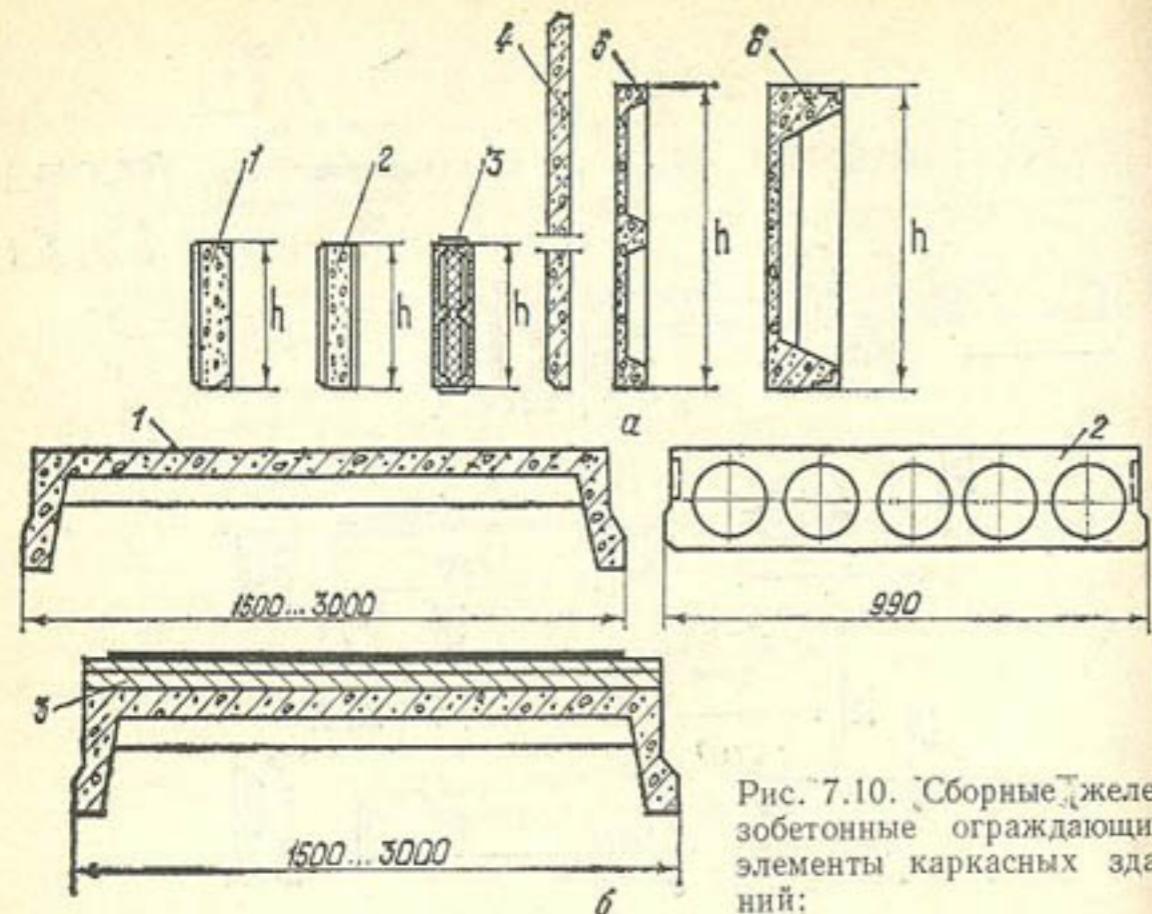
Сборные железобетонные ограждающие элементы каркасных зданий:
